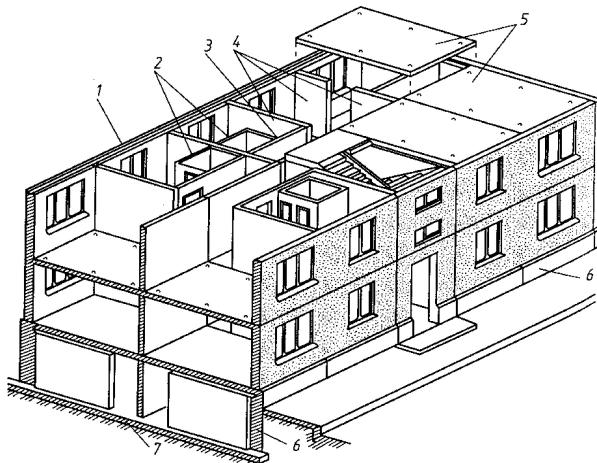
Конструктивная схема крупнопанельного дома с несущими стенами: 1 – наружные стеновые панели; 2 – санитарно-технические кабины; 3 – несущие перегородки; 4 – внутренние несущие поперечные стены; 5 – панели перекрытия; 6 – цокольные панели; 7 – блоки фундамента
